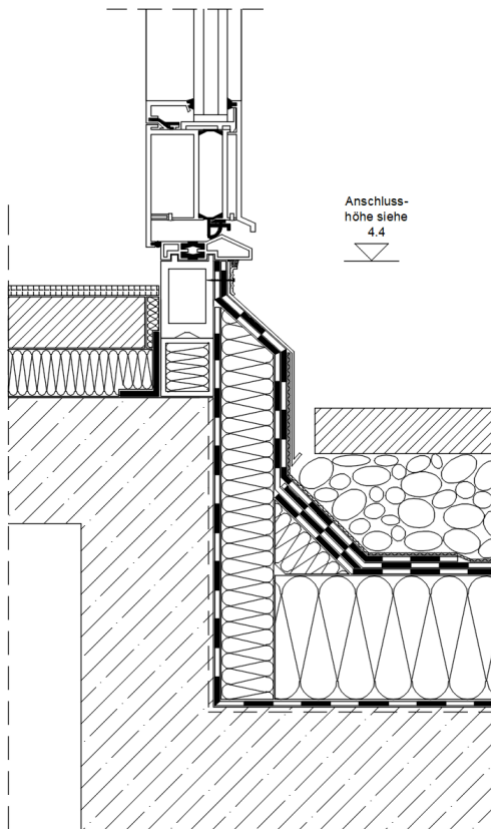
Terrassentüranschluss – Ausführung mit Bitumenbahnen und Schutzblech –
